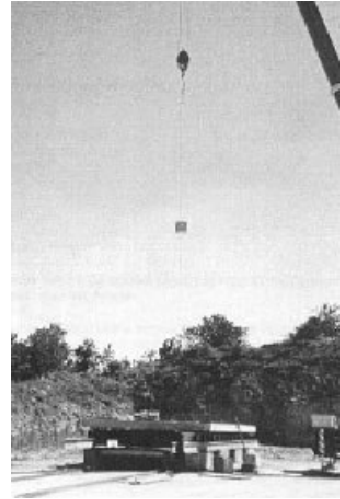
Essais de chutes de blocs menés sur dalle PSD à échelle 1/3
